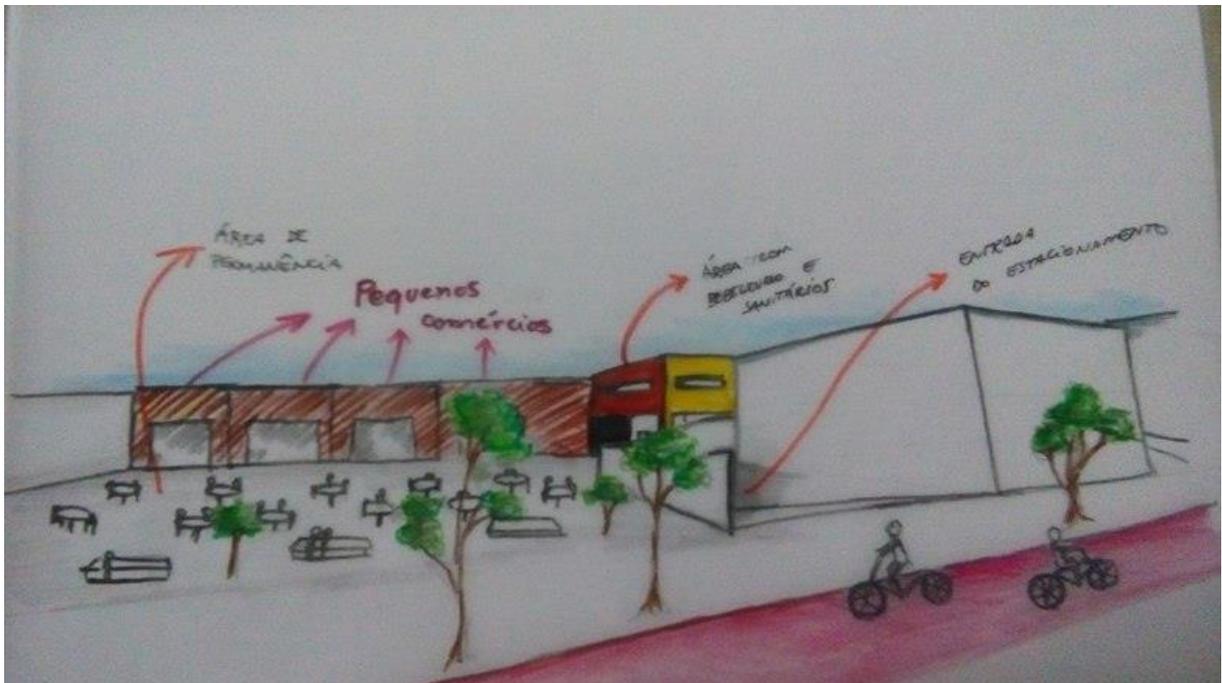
Croqui da praça. Fonte: Acervo pessoal
